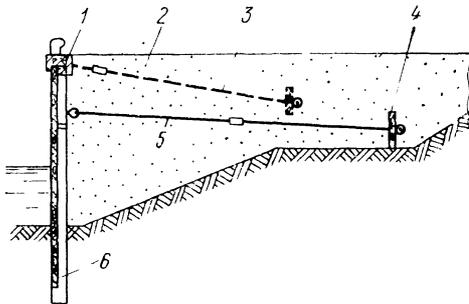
Больверк из таврового железобетонного шпунта для речных условий:
